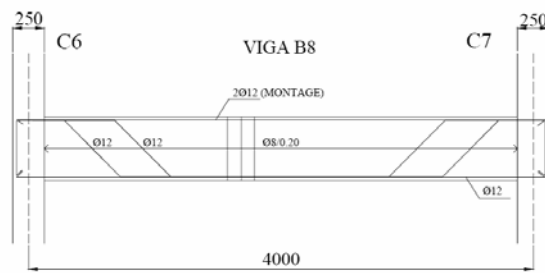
Alçado da viga B8 [mm] [Massena, 2004].
